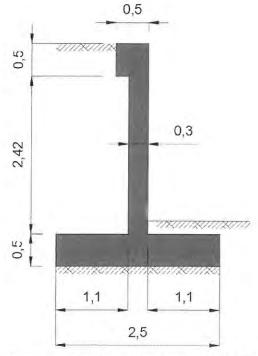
Detalle en corte transversal de muros de contención en Rosario Castellanos.
